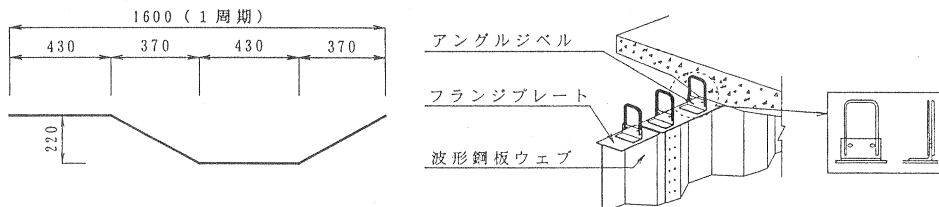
波形鋼板形状 コンクリートと鋼板の接合方法
